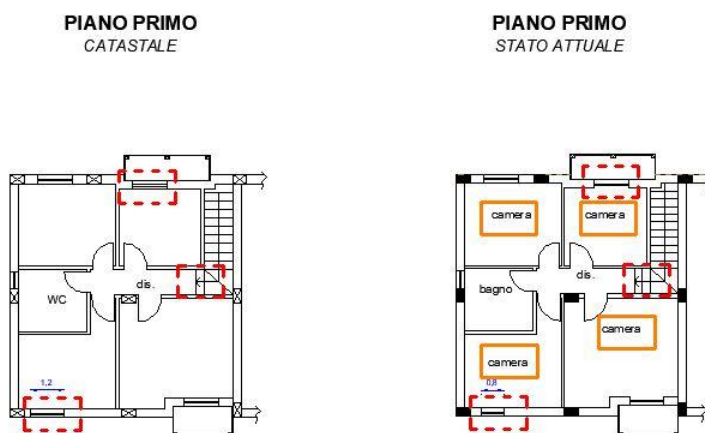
Confronto tra planimetria catastale e planimetria stato attuale
